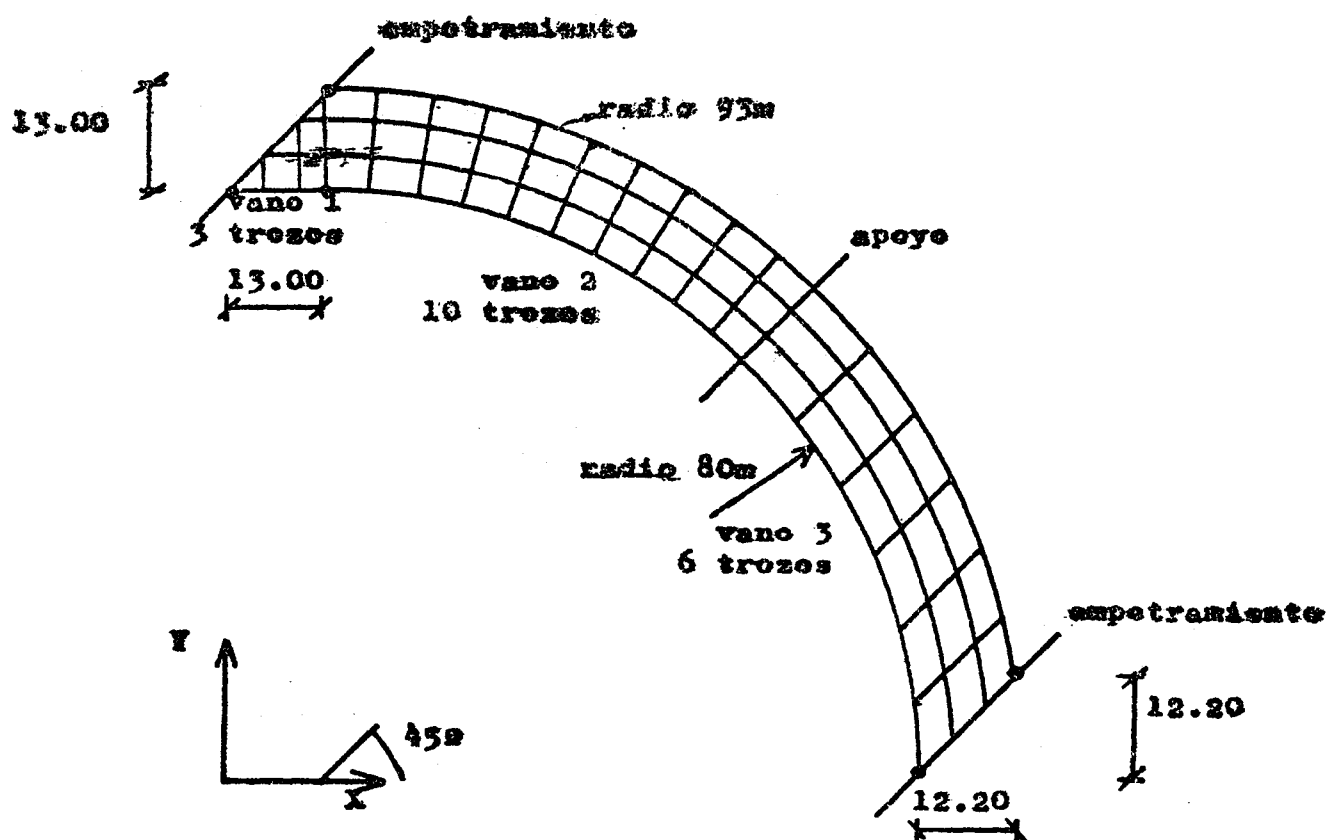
PLANTA DEL EMPARRILLADO
